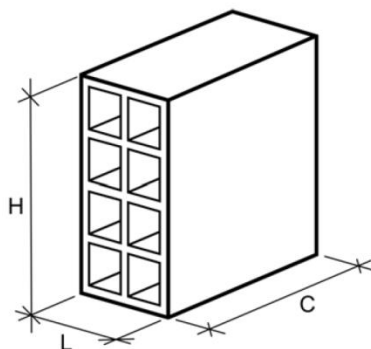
Bloco cerâmico furado de vedação com furos na horizontal.
